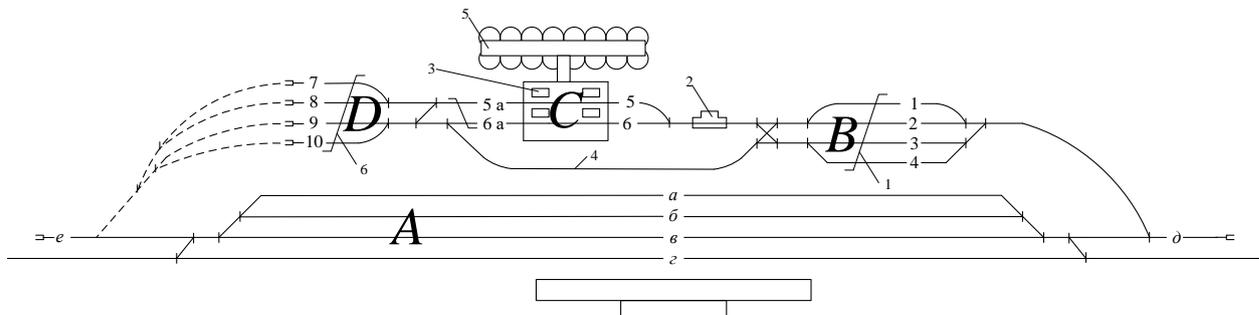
Схема передвижения зерновозов по подъездным путям элеватора для разгрузки и отправки порожних вагонов
